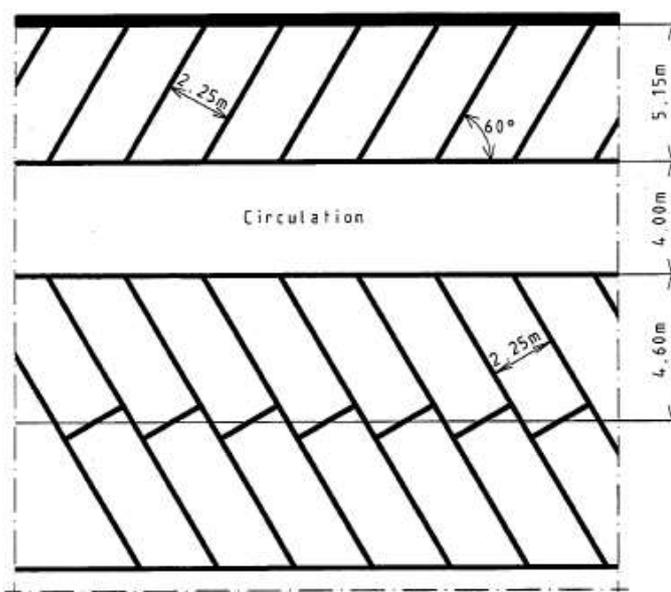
Places de classe A — Application du tableau 2 à un rangement en épi à 60°
